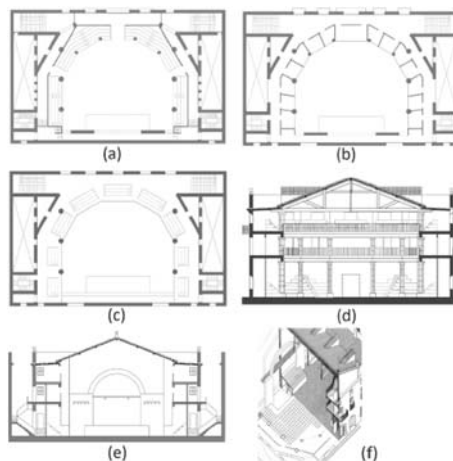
Planos de l’Olivera de Ros [4]: (a) platea, (b) primer piso, (c) segundo piso, (d) fachada, (e) sección de la fachada, y (f) sección axonométrica hacia el escenario.
